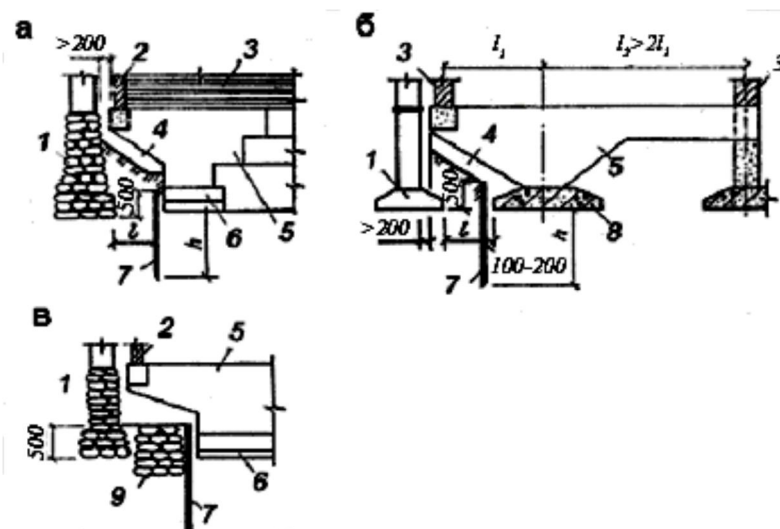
Консольне примикання до існуючих фундаментів нових будівель: а – із поздовжніми несучими стінами; б – із поперечними несучими стінами; в – зі збереженням фундаменту розібраної будівлі: 1 – існуючий фундамент; 2 – захисна стіна; 3 – стіна; 4 – зазор; 5 – монолітна частина стіни фундаменту з консоллю; 6 – розширення підшви фундаменту; 7 – шпунт; 8 – поперечний стрічковий фундамент; 9 – збережена частина старого фундаменту
